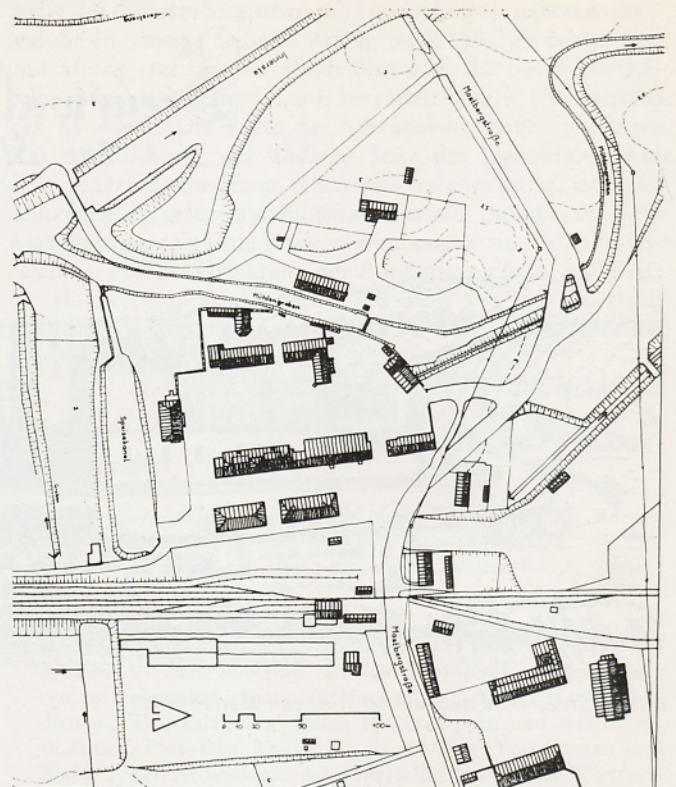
Steuerwald, Lageplan mit dem Gebäudebestand von 1976. Zeichnung: E. Schües
